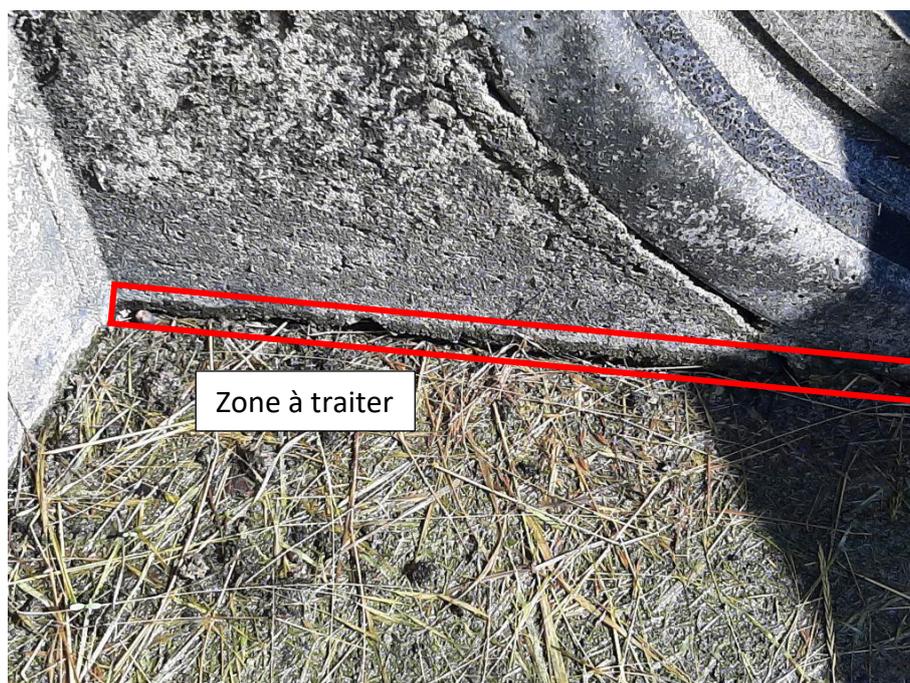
Photographie du pied du mur de la conduite de fuite (source : visite Antea Group du 25/06/2021)
